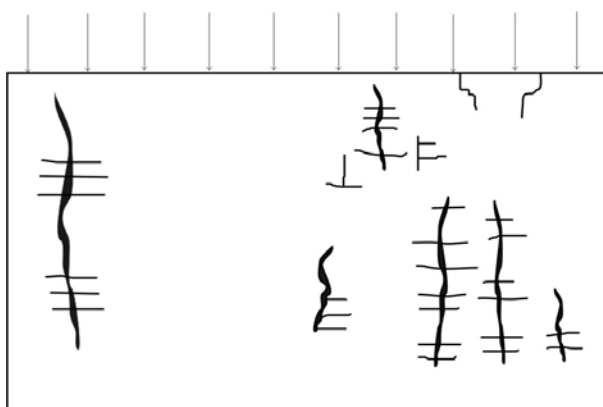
Fissuração típica da alvenaria causada por sobrecarga vertical (Argilés, 1999)
